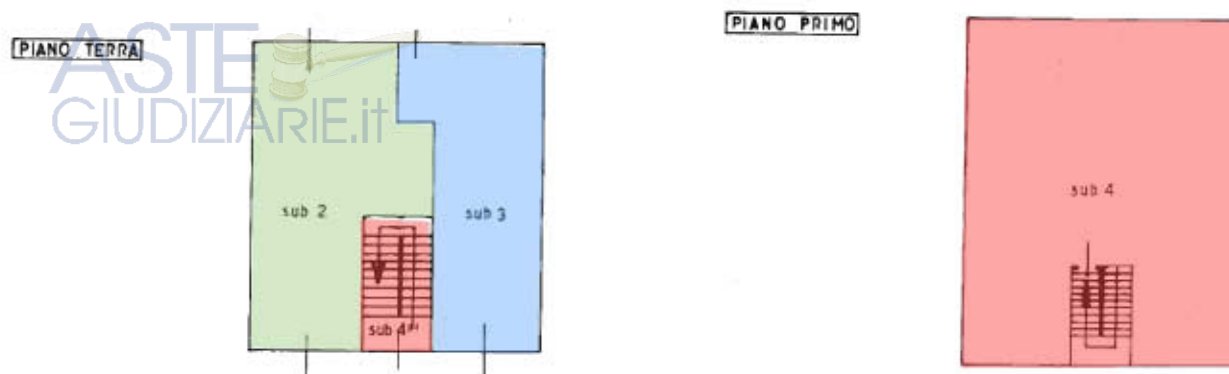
Stralcio elaborato planimetrico con ubicazione dei cespiti
